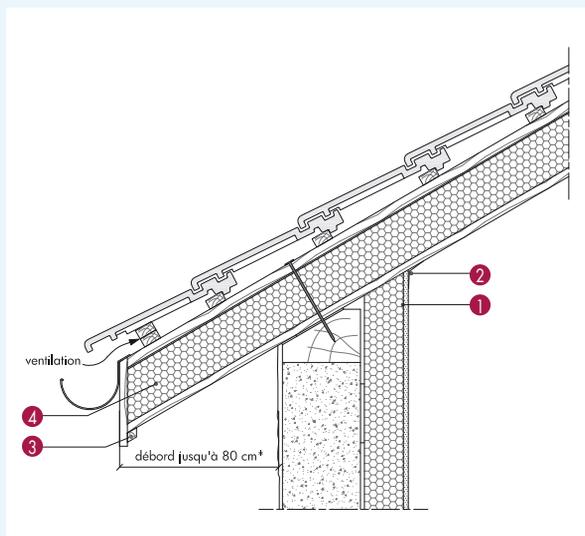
Égout en débord avec Fibratec ULTRA et Fibratec FM ULTRA Planche : planche de rive verticale
